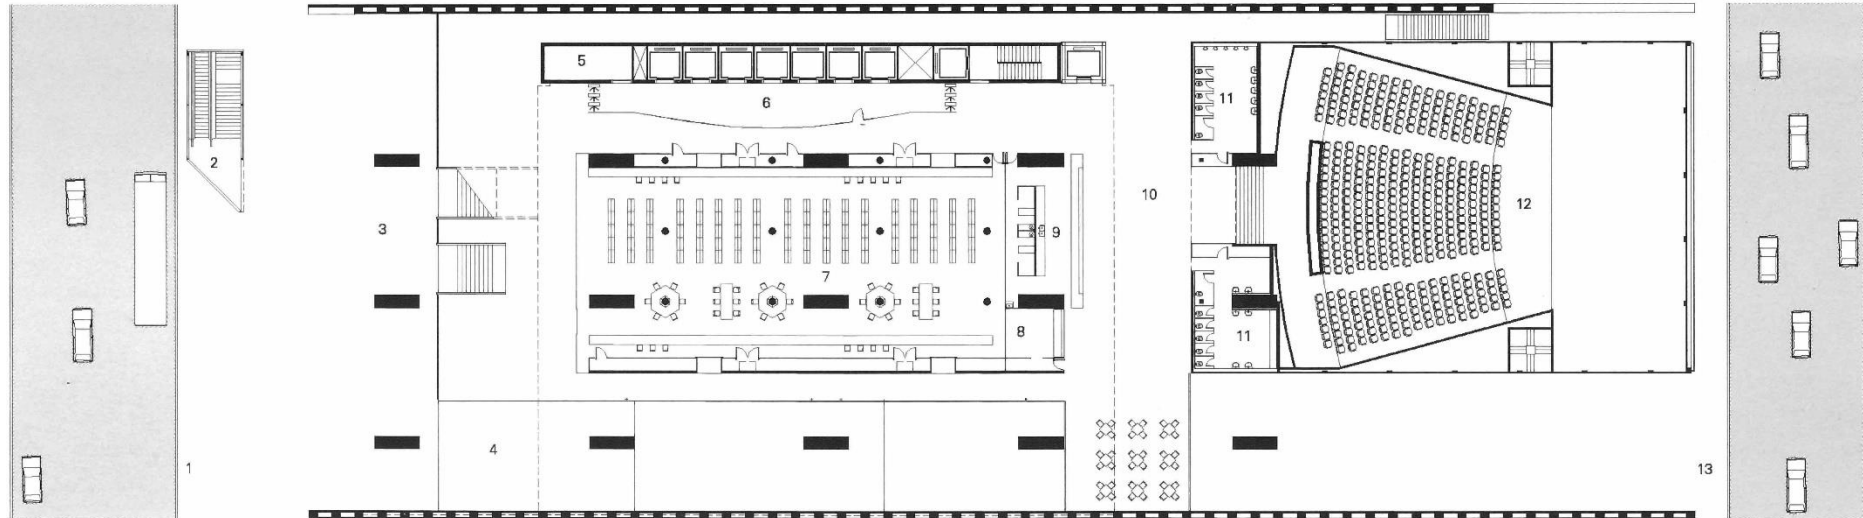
Pavimento térreo superior. Planta de formas, demolição e estrutura metálica
